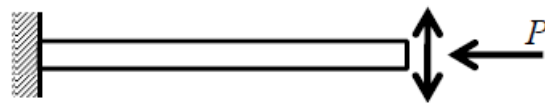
Esquema de pruebas Viga-Columna cíclicamente cargadas (Denavit *et al.*, 2011)
